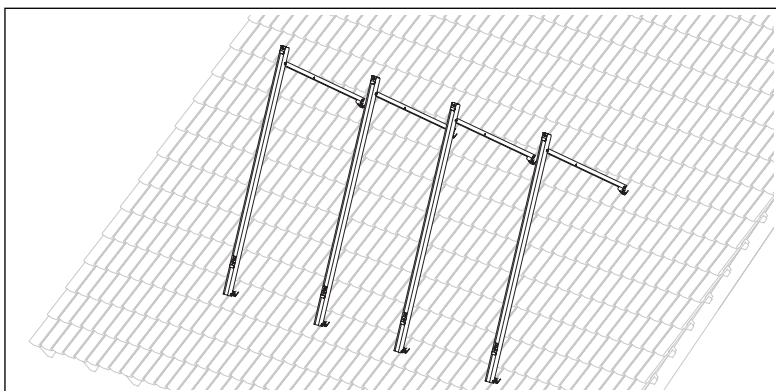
Konstrukci vzadu upevněte na závrtný šroub
